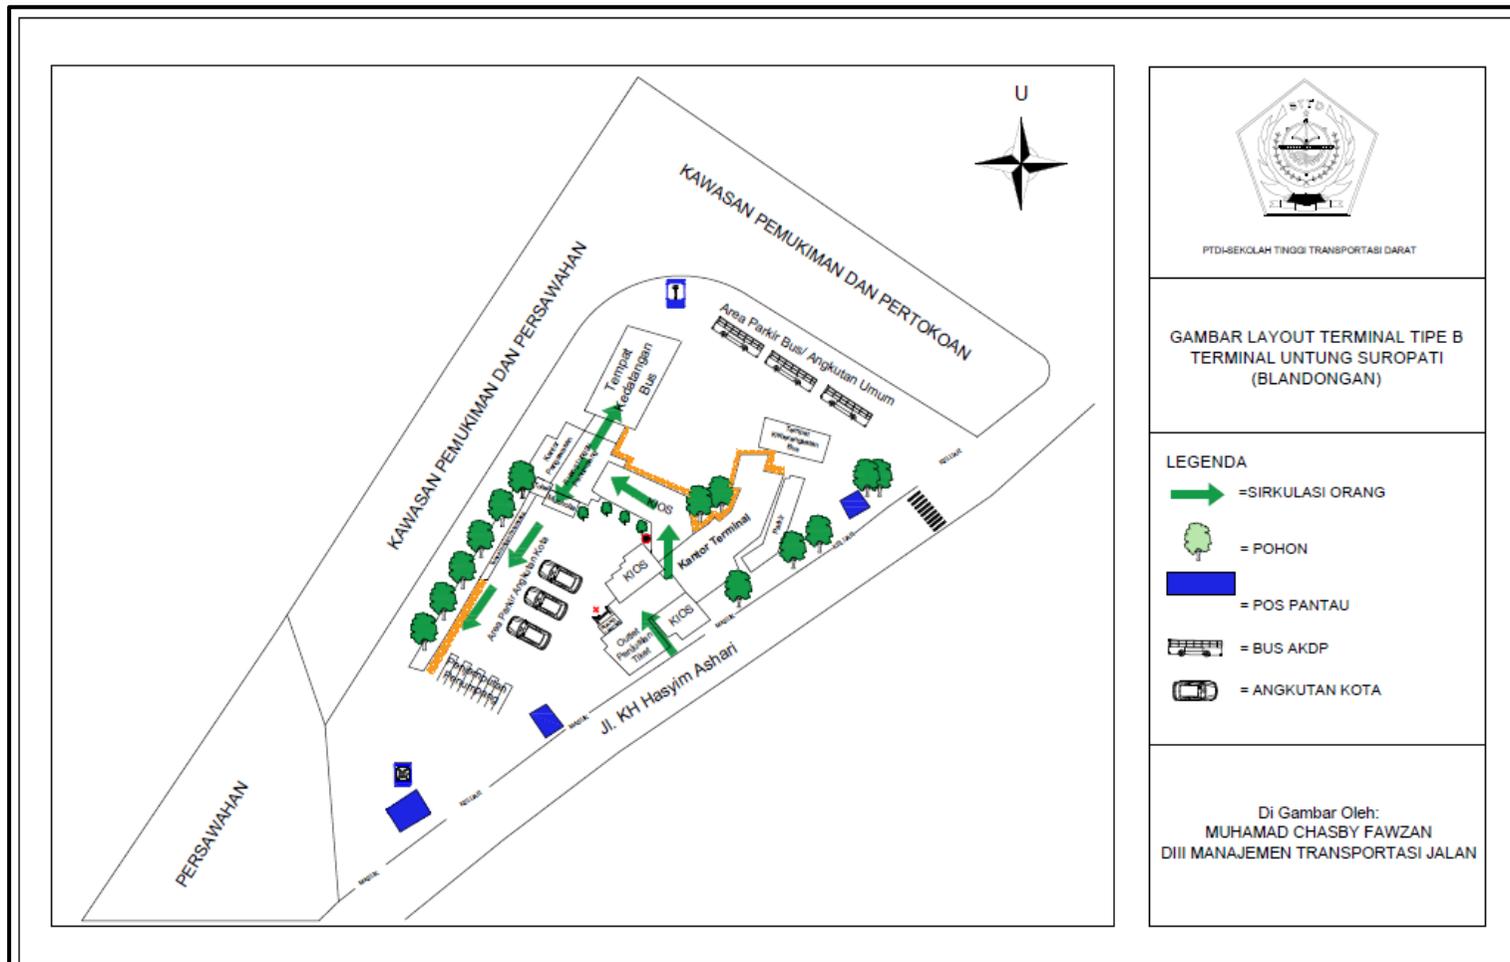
Layout Usulan Terminal Untung Suropati
